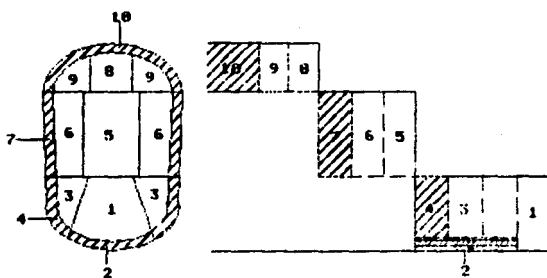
Método italiano, con excavación y hormigonado previo de la contrahueda, utilizado en terrenos con grandes empujes horizontales.
